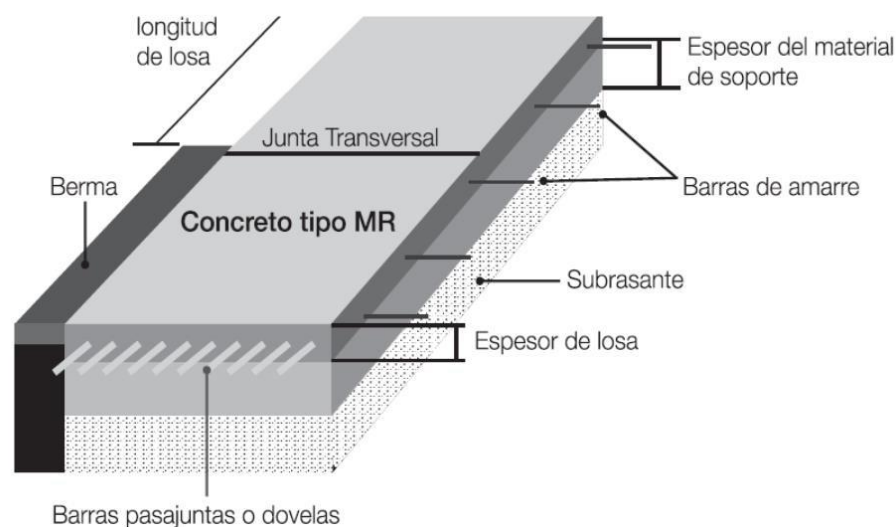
Diseño 3D de Losa de Pavimento. Fuente:(Grupo inversor G24)
